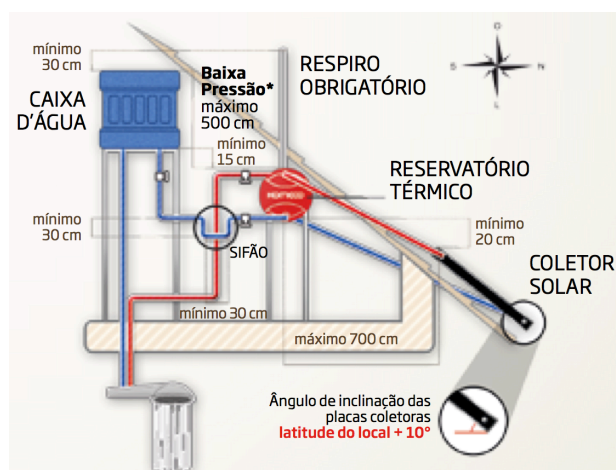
Instalação de um sistema de aquecedor solar plano
